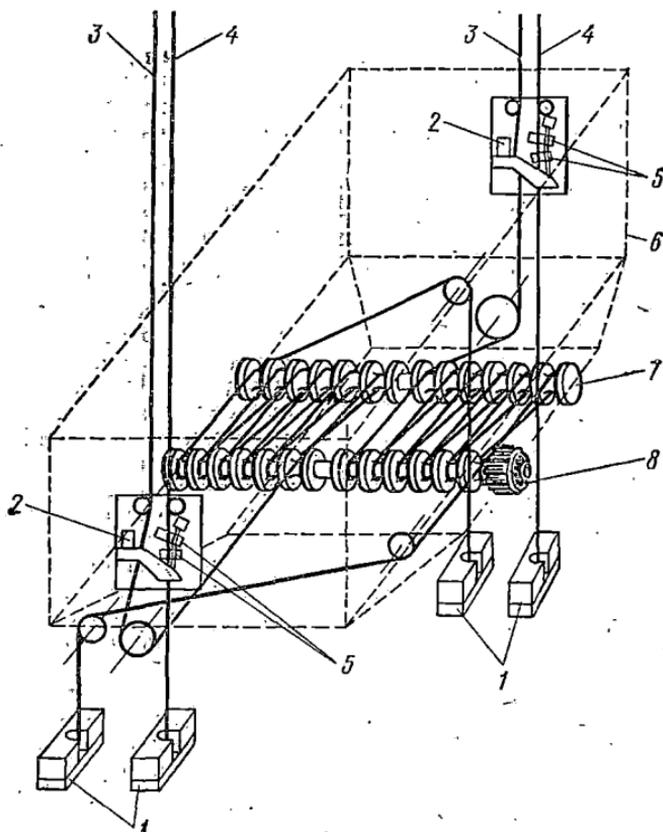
Схема запасовки канатов для люльки ЛС-80-250:
